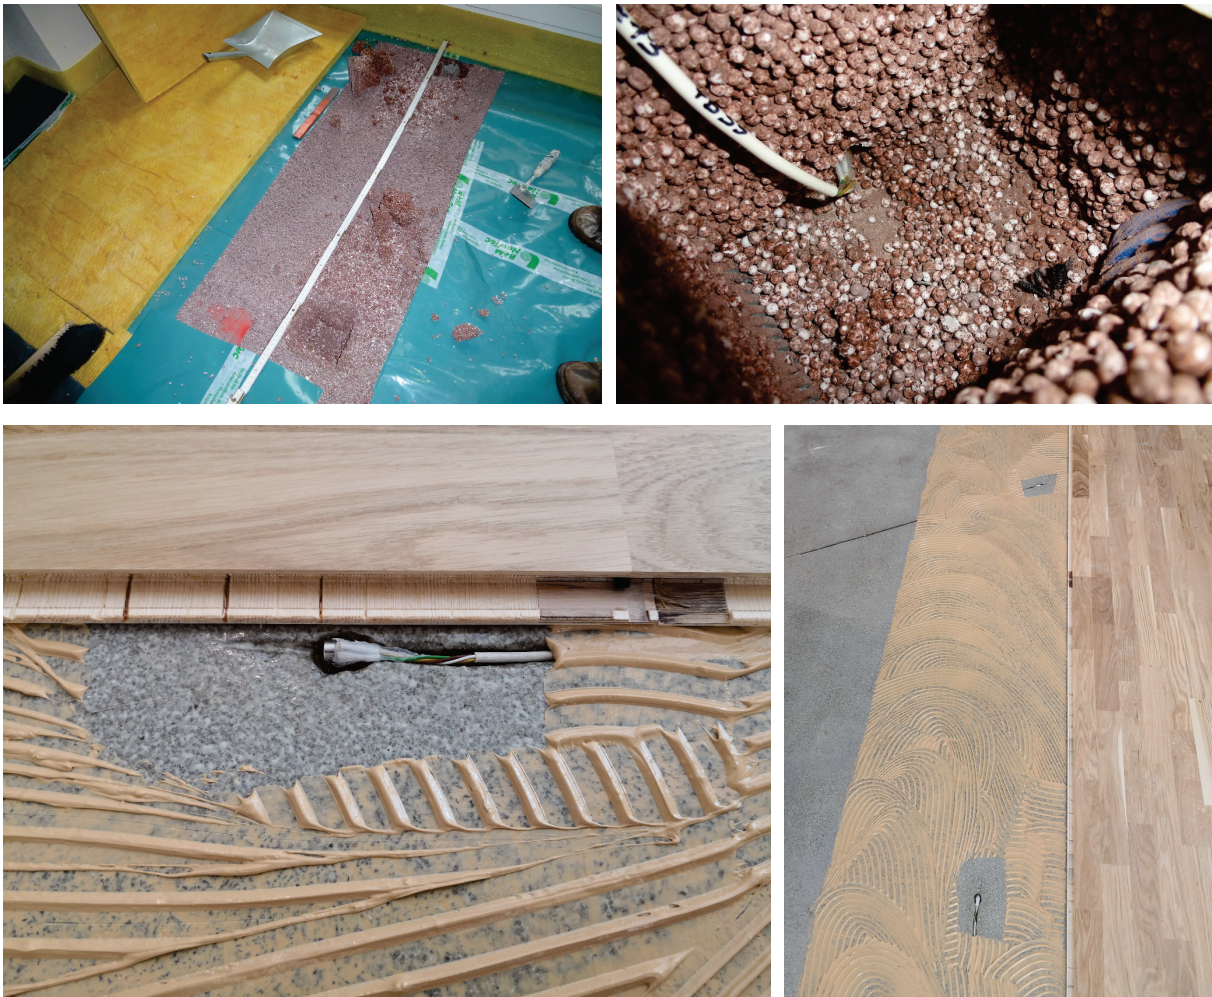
Montage der T/reILF-Kombisensoren im Fußbodenaufbau; gebundene Schüttung mit Folie und Trittschalldämmung (oben links); Lage des Sensors unter der gebundenen Schüttung (oben rechts); Lage des Sensors zwischen Estrich und geklebtem Parkett (unten links und rechts);
